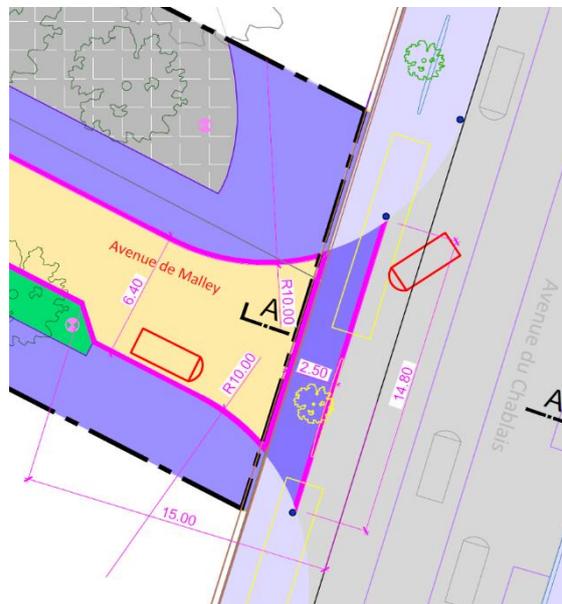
Vue en plan du carrefour Malley-Chablais, Groupement Mhust, 2022
